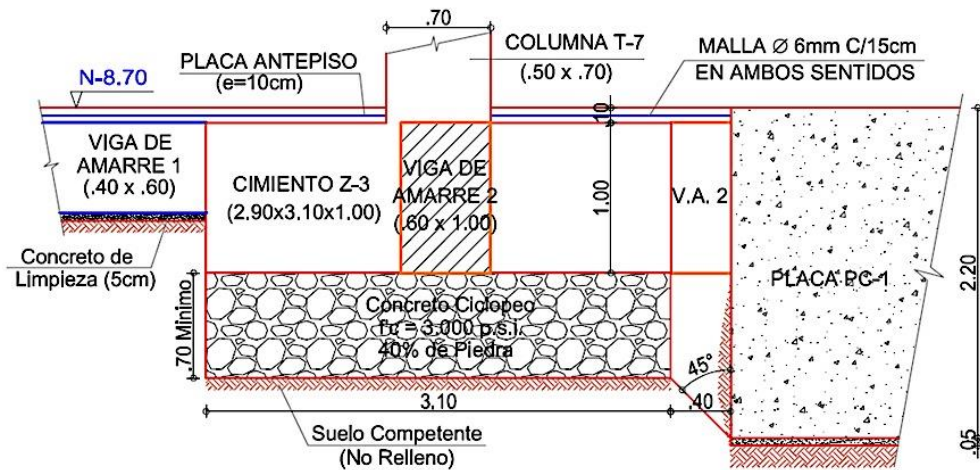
Corte en perfil en cual se detallan los elementos que llegan al nodo y el concreto ciclópeo bajo cimientos.
